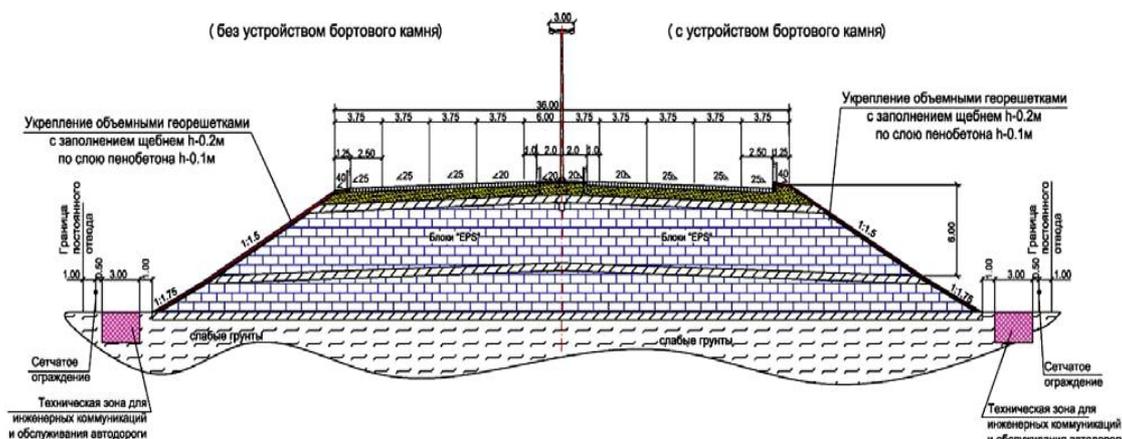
Схема комбинированной дорожной насыпи на слабых грунтах с применением EPS-блоков и пенобетона
